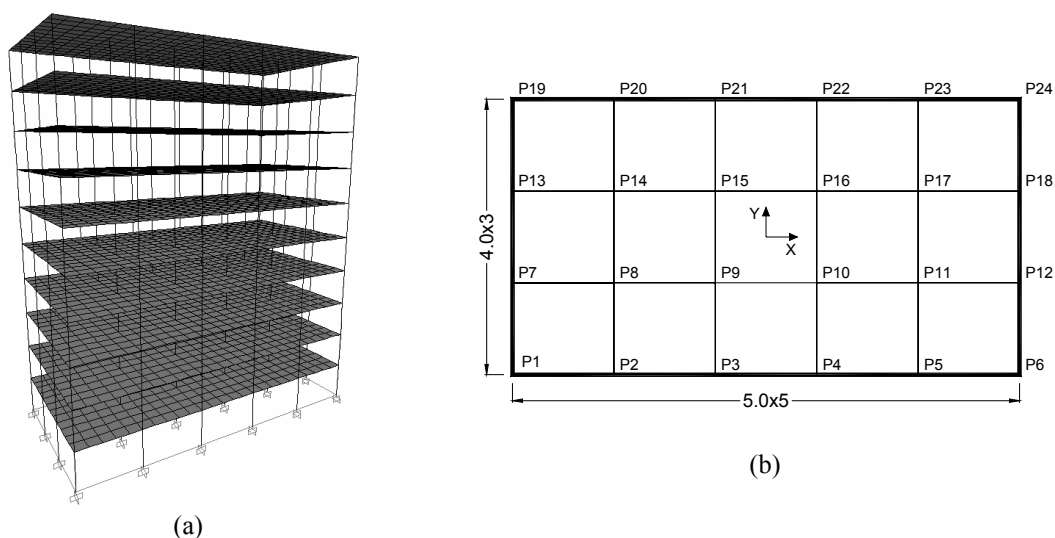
Estrutura base: (a) Perspectiva; (b) Planta esquemática.
